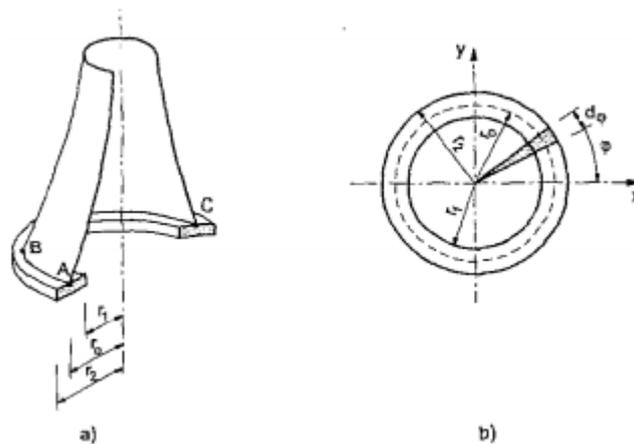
Vista en alzado y planta del cimiento anular. Fuente: "Cálculo de Estructuras de Cimentación" José Calavera Ruiz
